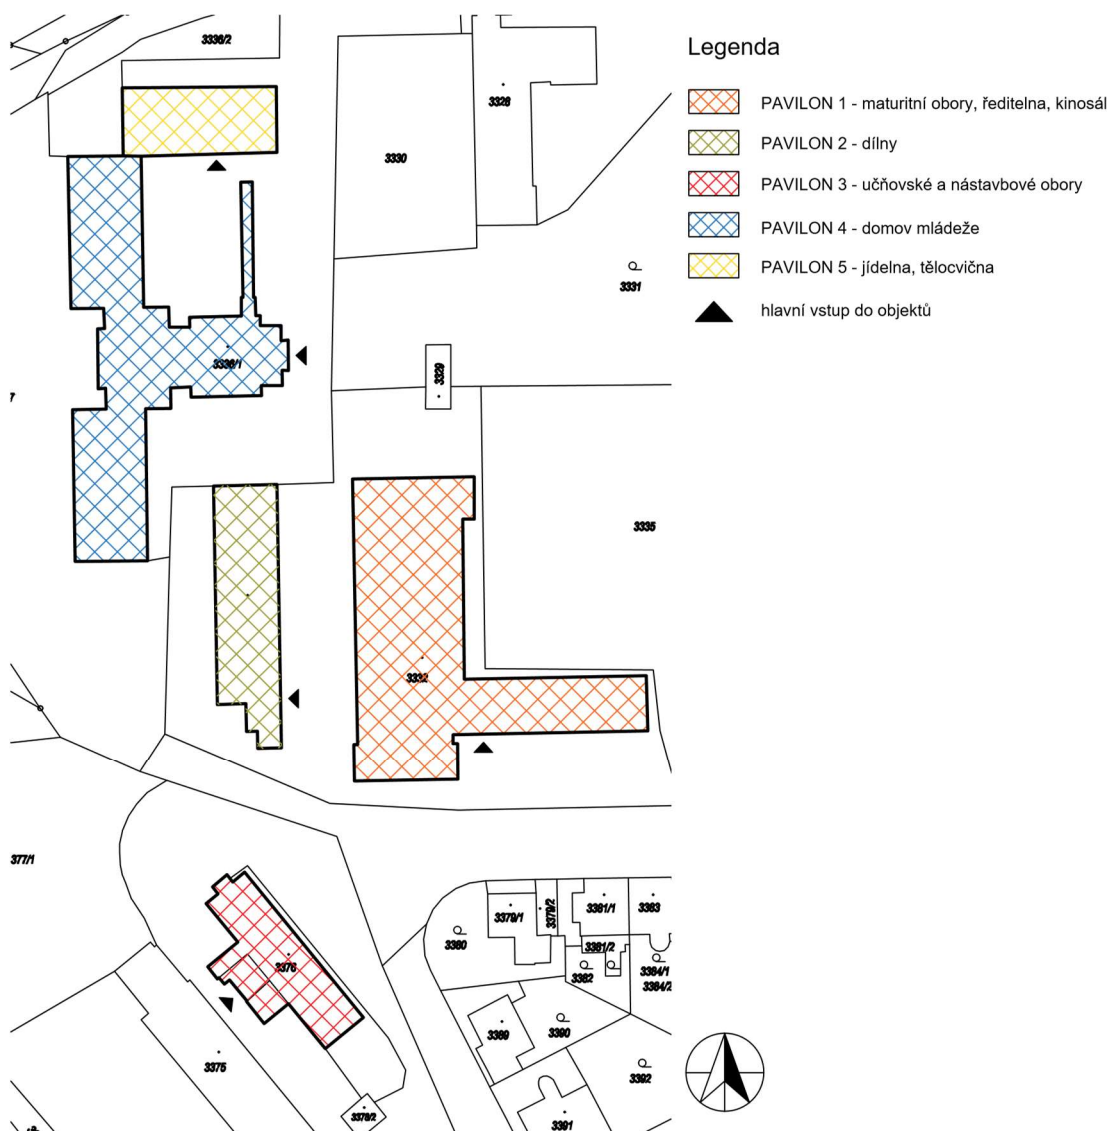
Mapové zobrazení posuzované budovy [10]
